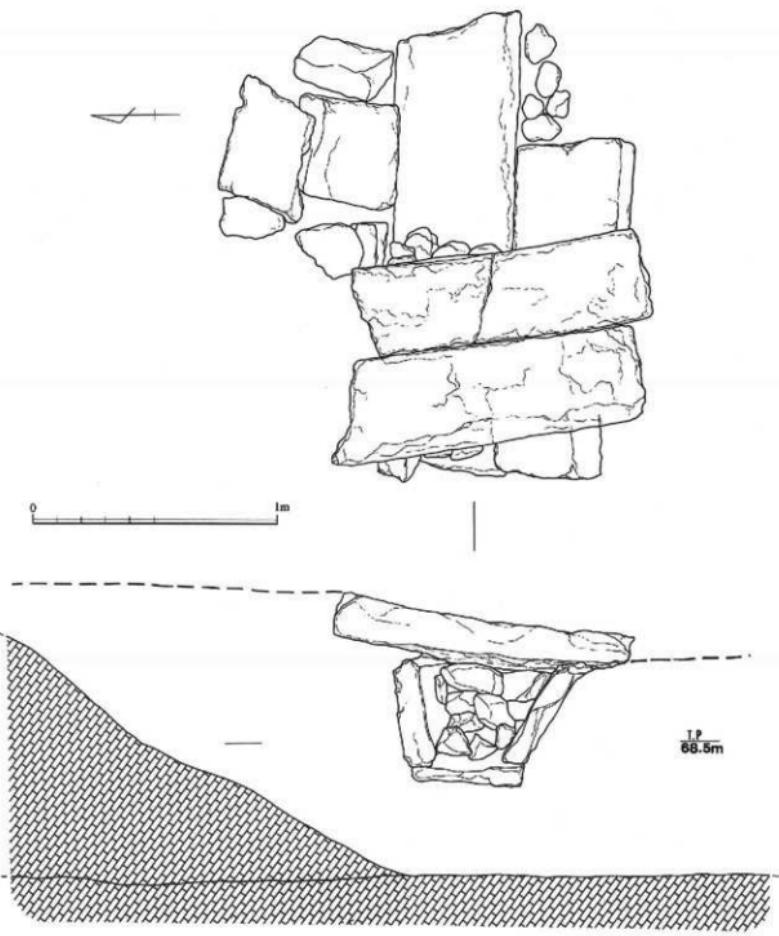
西除崩壊部石組1平面・立面図 (S-1/20)
